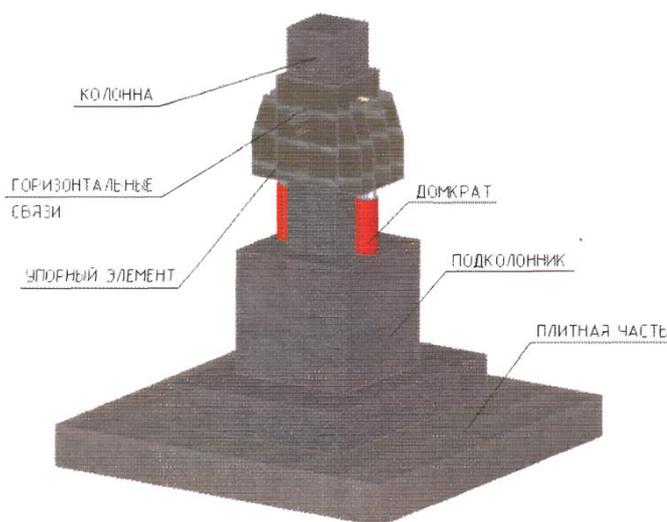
Регулируемый фундамент для эксплуатируемых зданий с железобетонным каркасом
